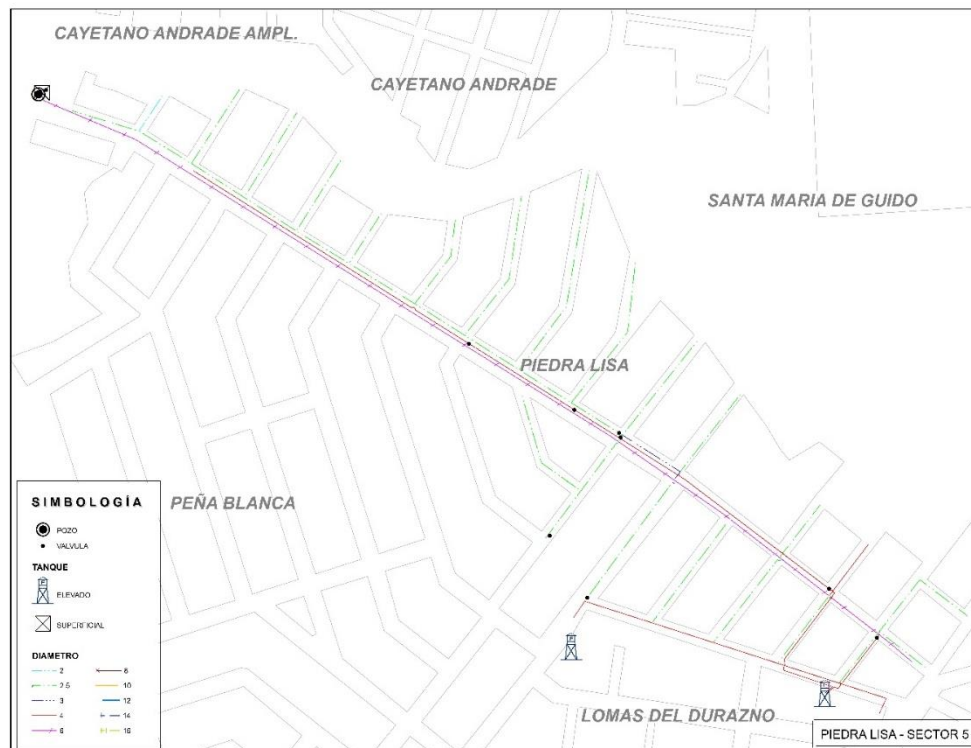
Plano original de la colonia Piedra Lisa del sistema de catastro digital de OOAPAS
